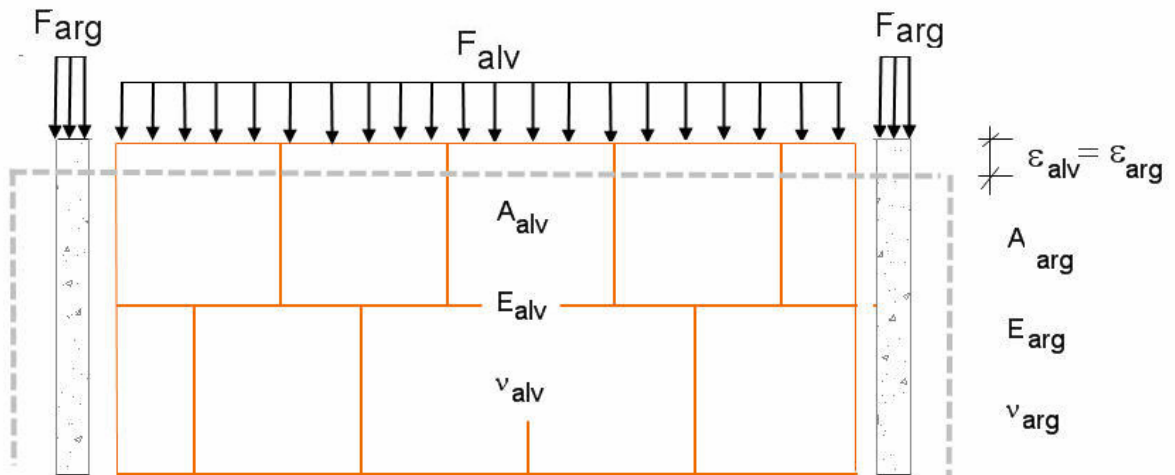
Distribuição do carregamento no conjunto argamassa armada/alvenaria
